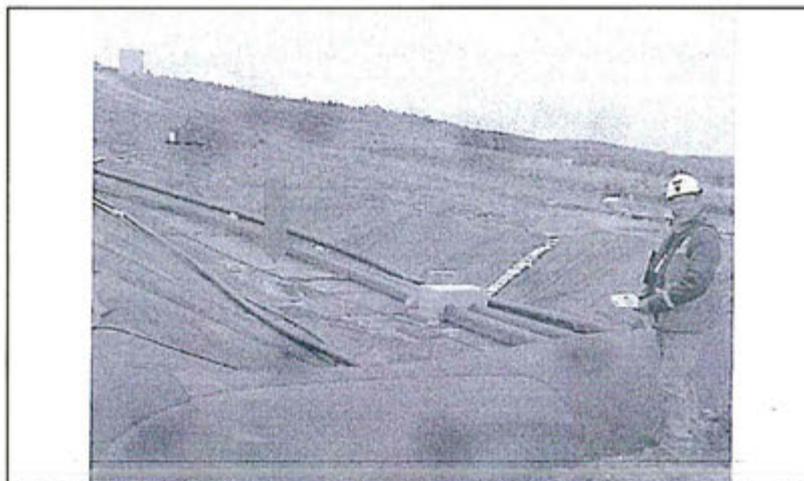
Cumplimiento de recomendación N° 4-2011: Otra vista de la Verificación del canal que conduce al Pad de lixiviación Yanacocha Norte que cuenta con mantenimiento y limpieza de sedimentos
